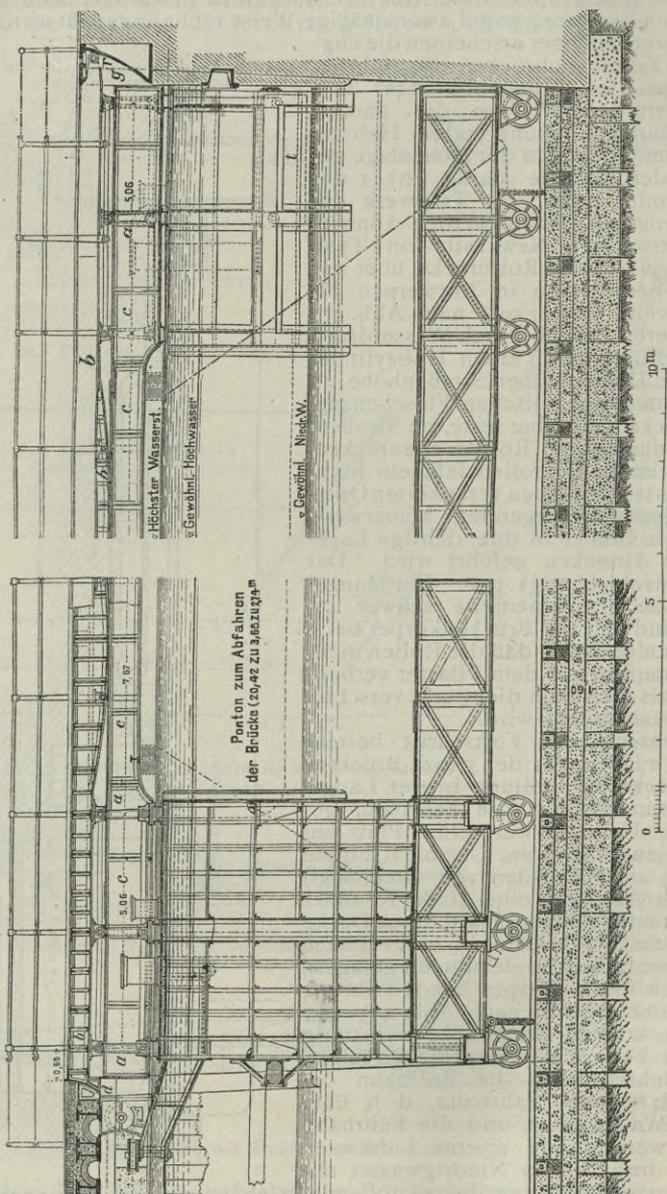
und 476. Kimpfle's Rollbrücke in Greenock (Längsschnitt und Längsansicht).
